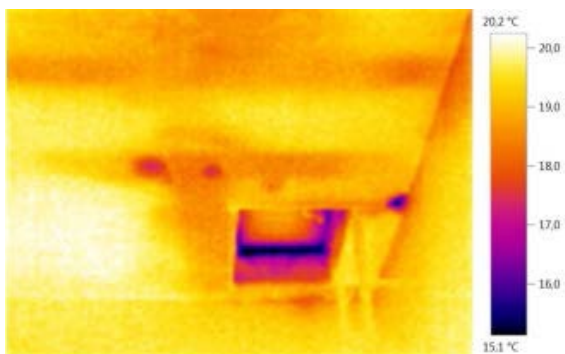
б - Покрытие (кровля) на лестничной клетке
